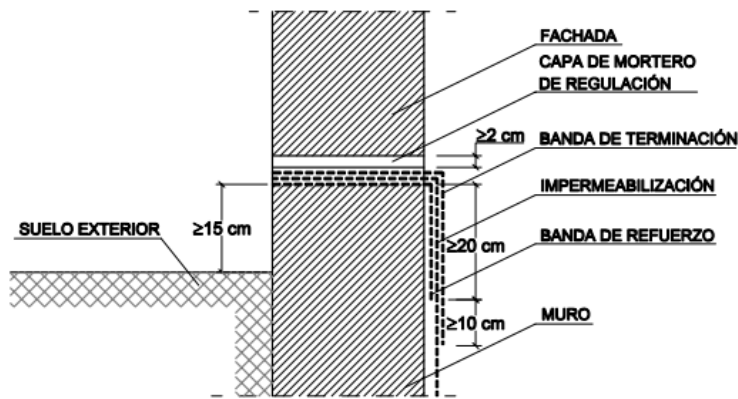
Ejemplo de encuentro de un muro impermeabilizado por el interior con lámina con una fachada
